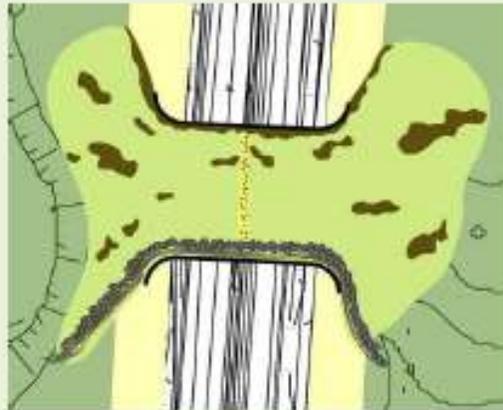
Principe d'aménagement d'un ouvrage grande faune
